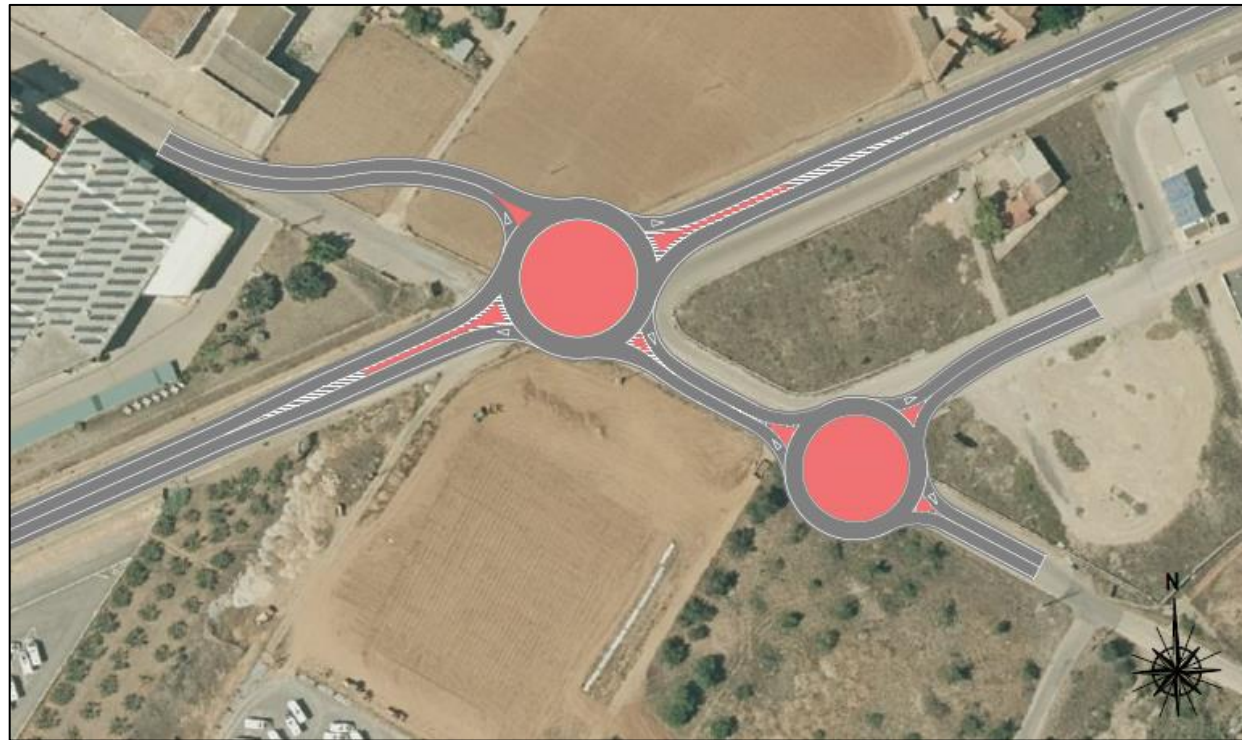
Imagen en planta con la solución proyectada. Fuente: elaboración propia.
